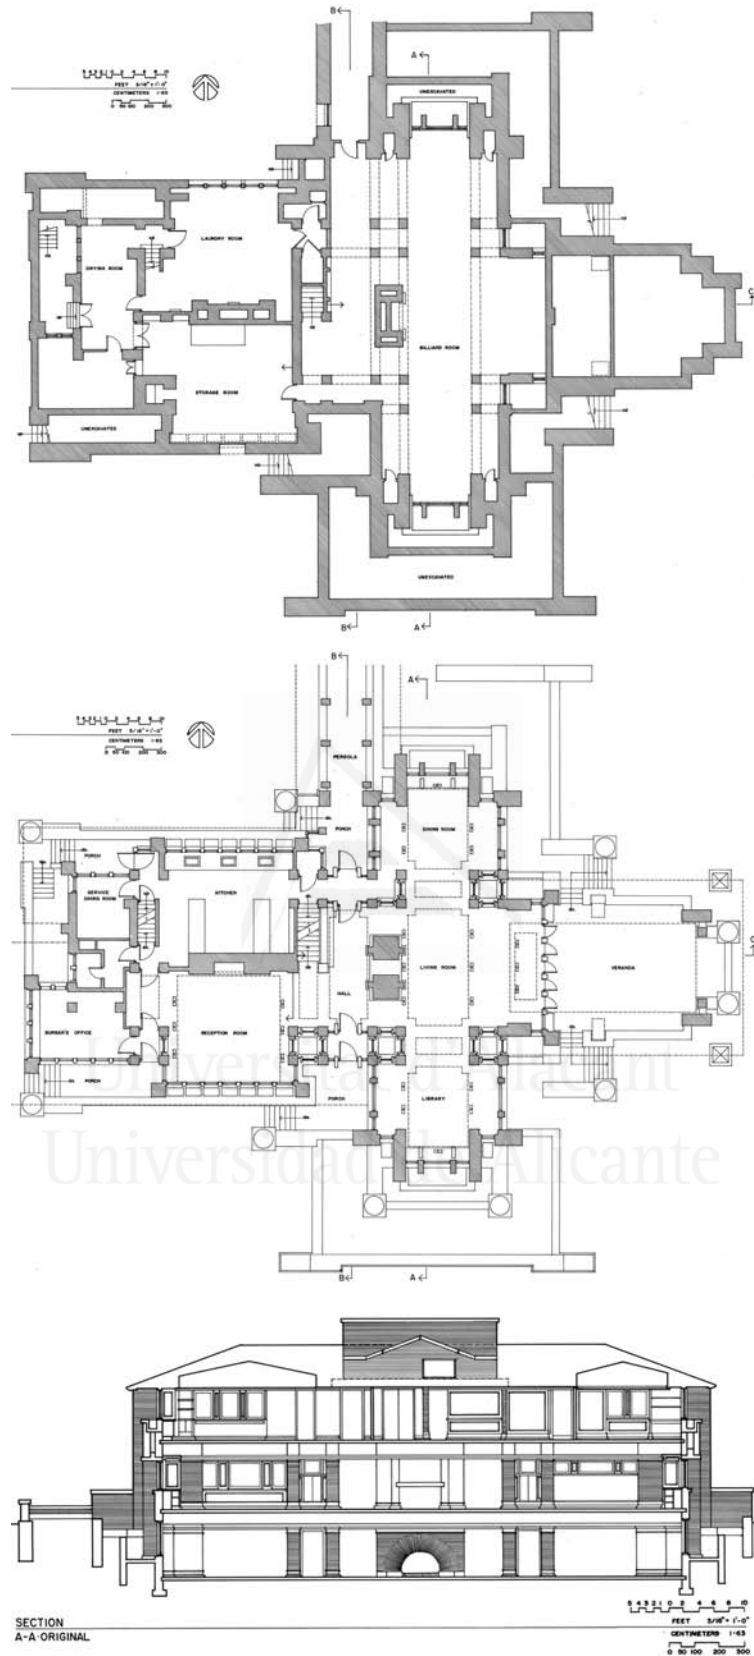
Planta baja, planta del primer nivel y sección de la Darwin D. Martin House, Frank Lloyd Wright, (1903-1905). Ilustraciones extraídas de Internet, Biblioteca del Congreso de Estados Unidos (Historic American Buildings Survey), <http://www.loc.gov/pictures/search/?q=Drawing:ny0203&fi=number&op=PHRASE&va=exact&co=hh&st=gallery&sg=true>.
